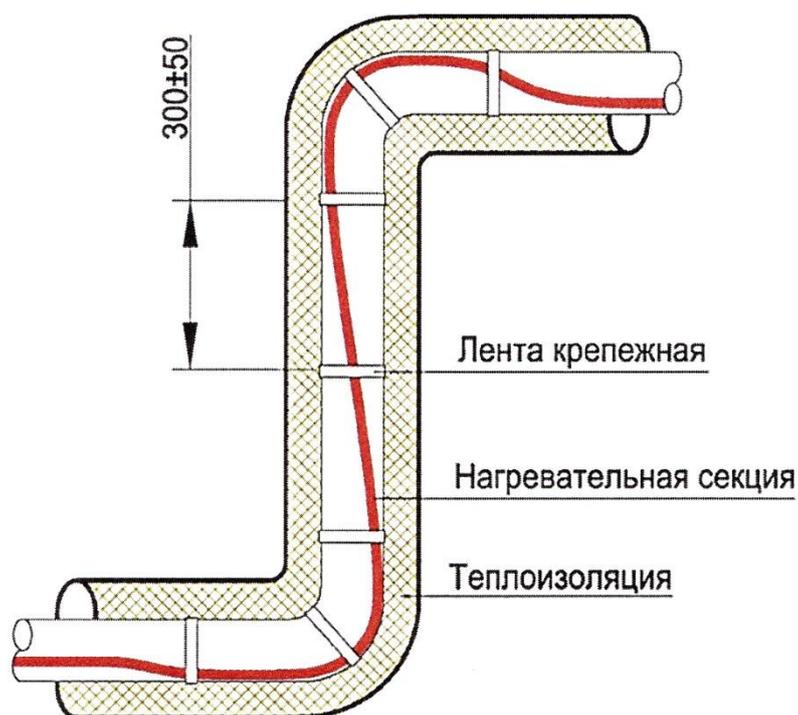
Укладка нагревательного элемента на трубном изгибе
